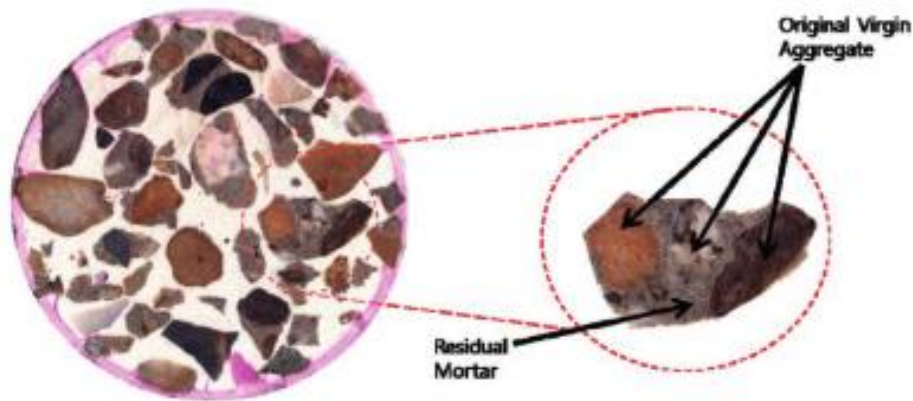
Бетон з щебнем із бетонного брухту
